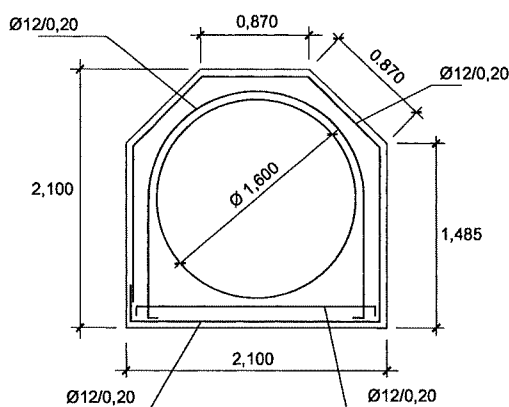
Sección tipo del dado de hormigón con chaflán y su armadura (RB.8)
